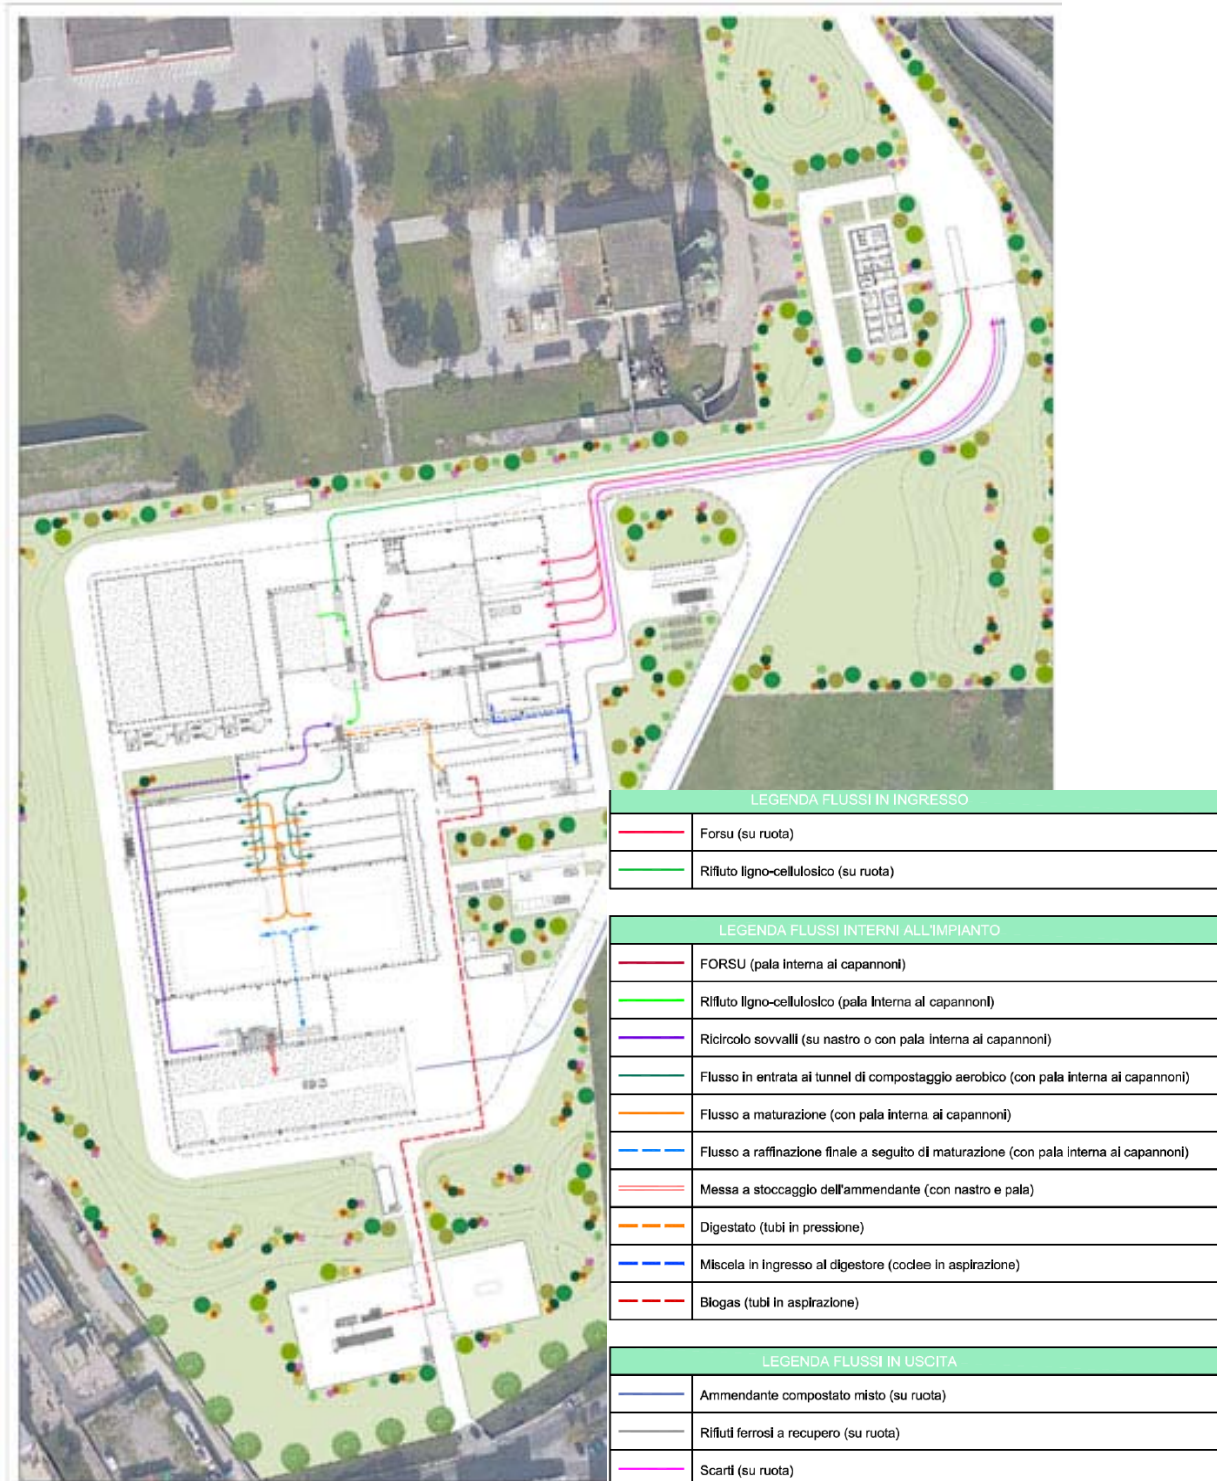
Layout dei flussi di movimentazione - Estratto tavola TEC_009
